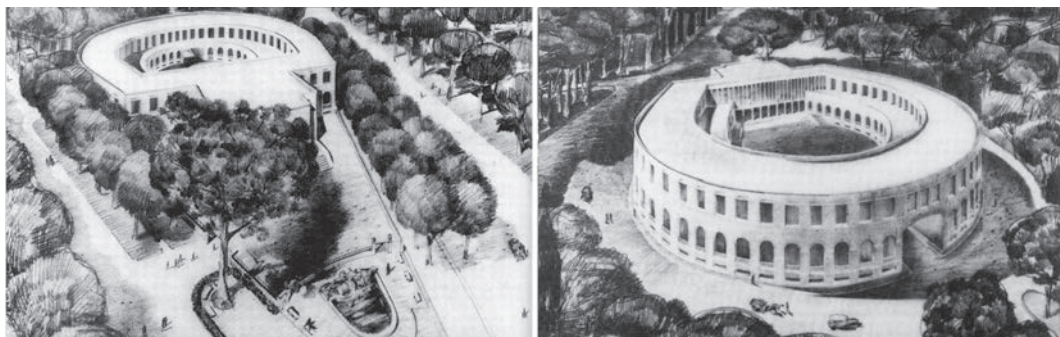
Viste prospettiche dei due fronti del progetto originale di Michelucci
